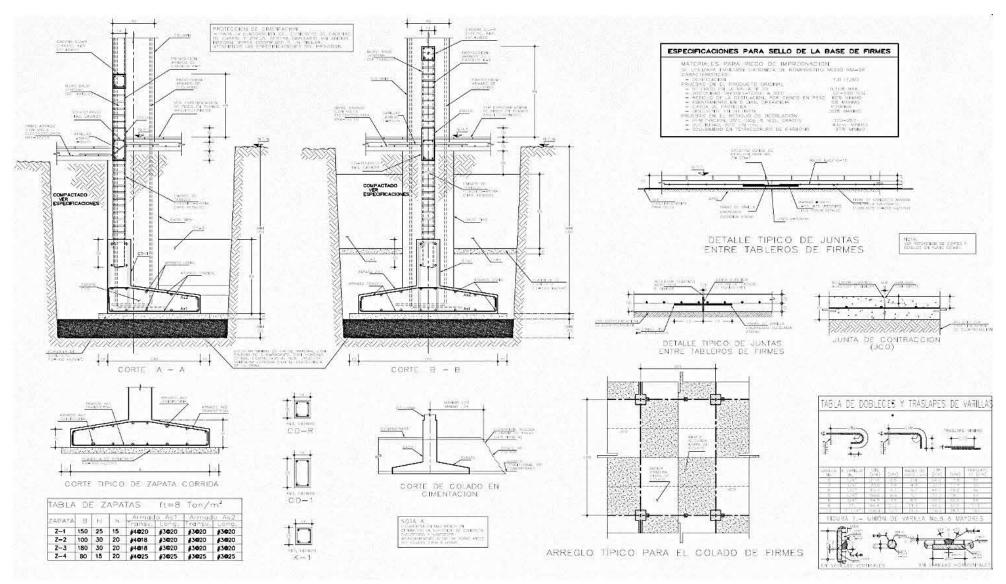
Planos de detalles y especificaciones complementarias (Dependiendo del tipo de cimentación).
